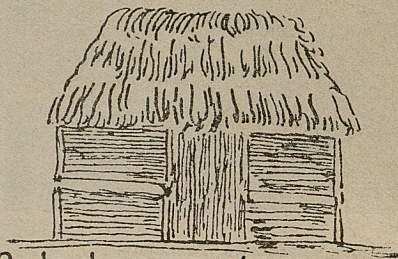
jacal con muros de varas y techo de paja o palma.
